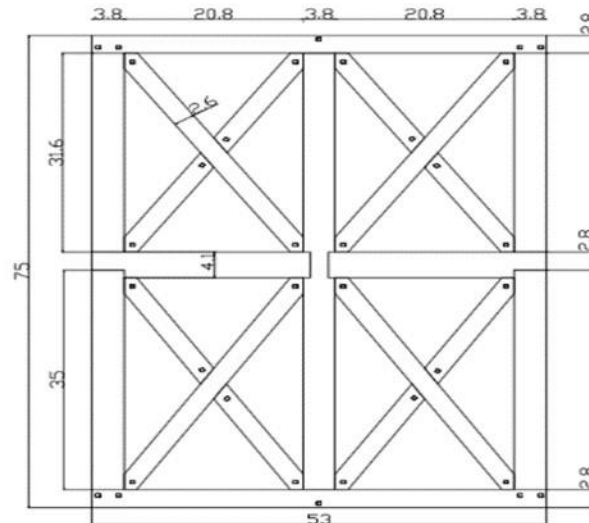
Örnek Yapının 1. Kat Plan Görünüşü
